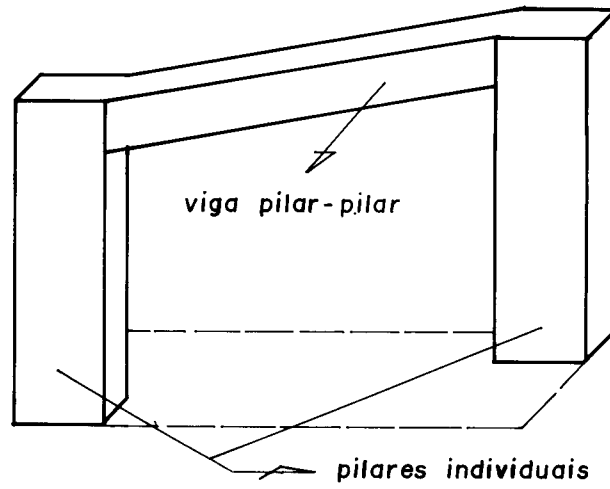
Contraventamento entre pilares individuais.
